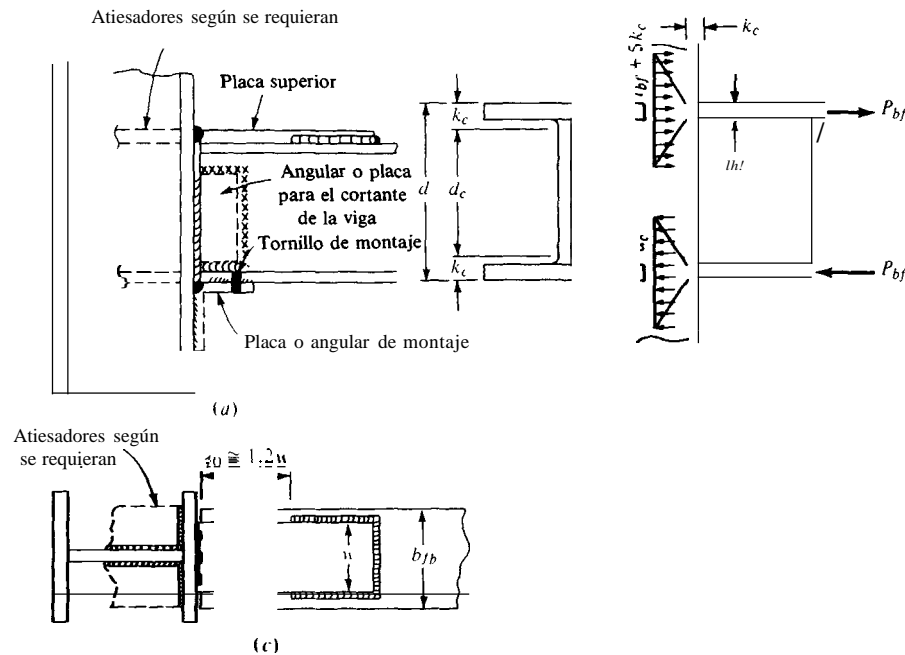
Conexiones rígidas soldadas de viga a columna, que son de uso común. (a) Conexión rígida. (b) Zona de esfuerzo en el alma de la columna; identificación de los términos usados en la ecuación (9-1). (c) placa superior y soldaduras.
